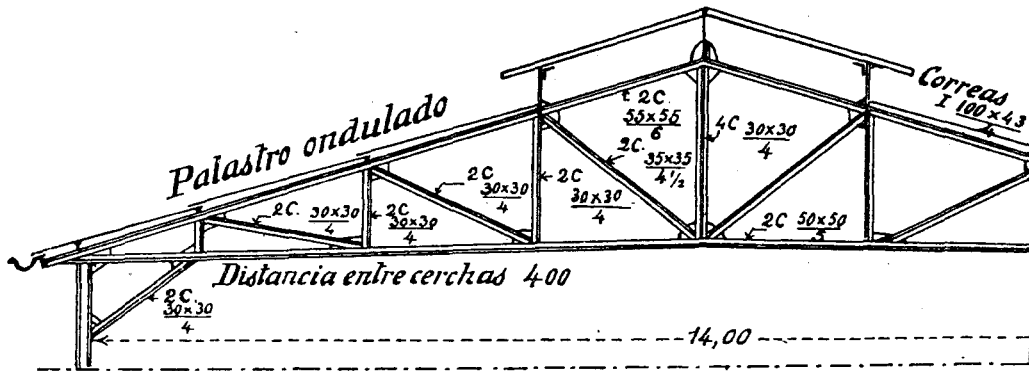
Armadura inglesa de 14,00 m de luz, con separación de 4,00 m entre cerchas.
